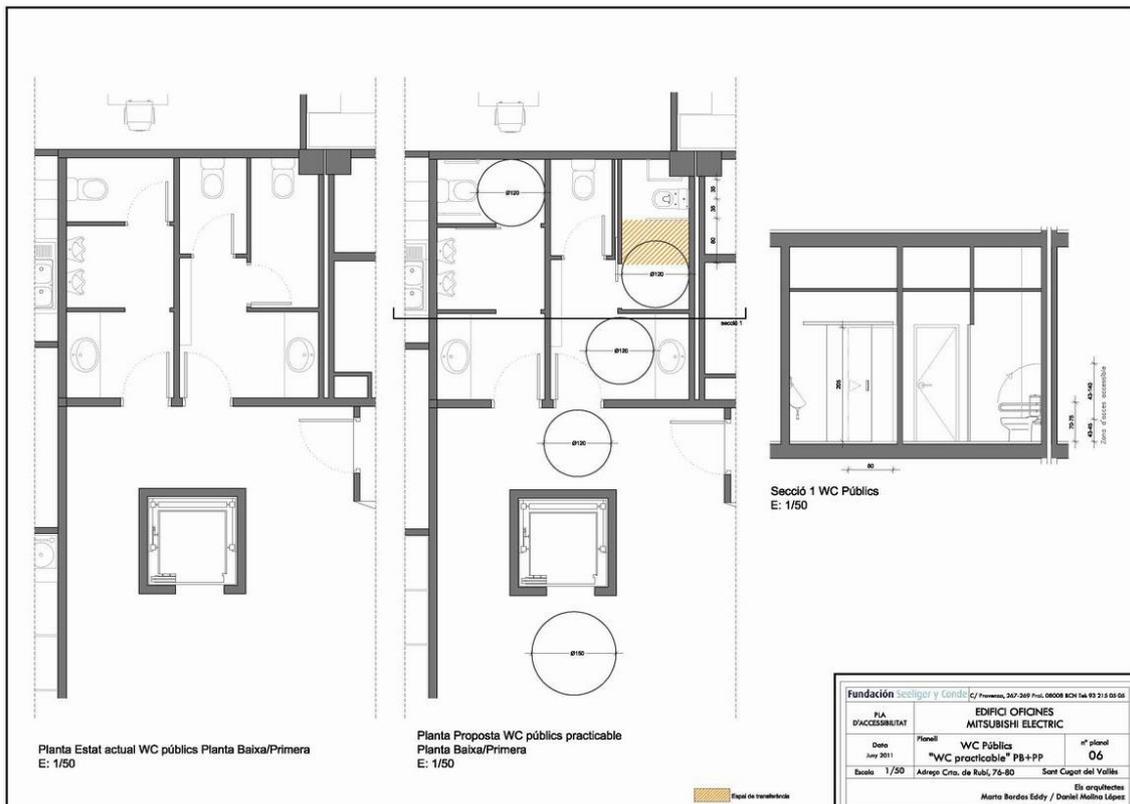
Edificio Oficinas MITSUBISHI ELECTRIC. Planta estado actual y propuesta nueva baños públicos de Planta Primera.
